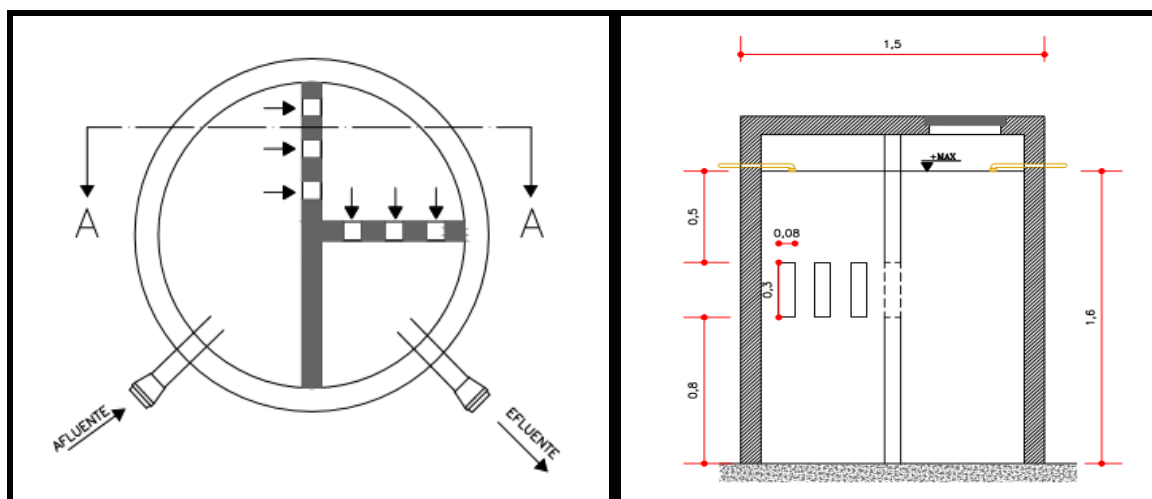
Planta baixa e corte lateral do Tanque Séptico.
